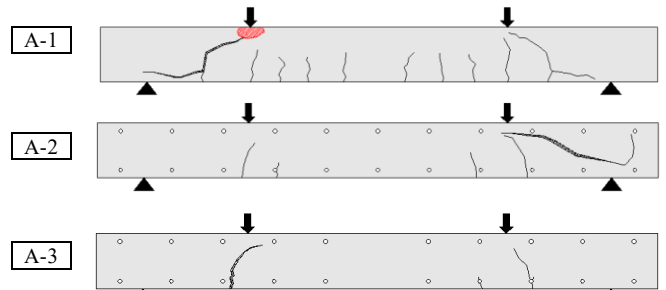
側面のひび割れ図 (A-1~3)
